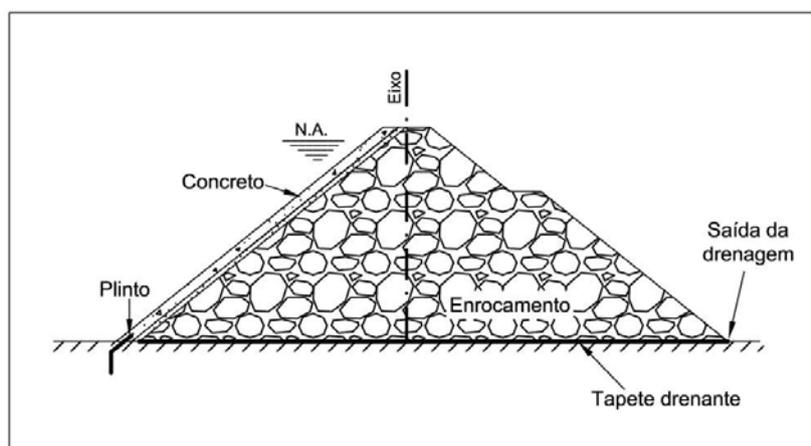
Corte transversal ao eixo de uma barragem de enrocamento com face de concreto. Notar a placa de concreto sobre o talude de montante e no final o Plinto que faz a conexão entre o concreto e o maciço rochosos de fundação.
